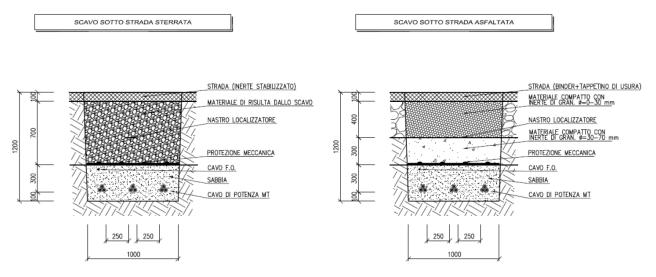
Sezioni di progetto relative alla disposizione dei cavidotti al di sotto della rete stradale
